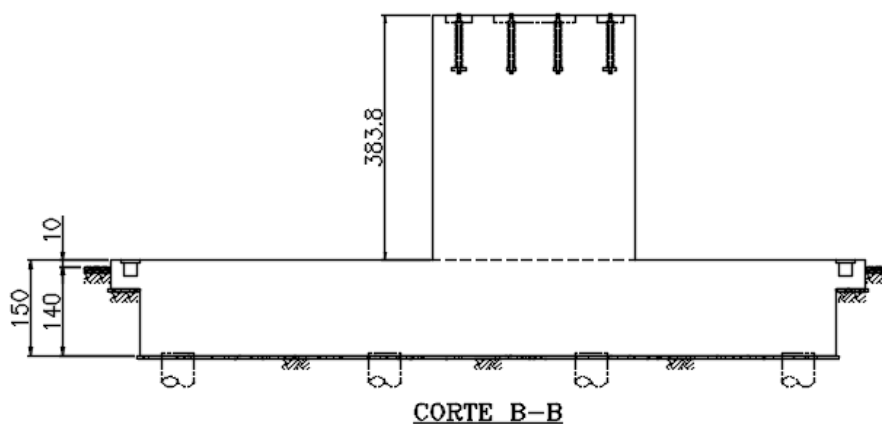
Modelo estrutural: elevação da fundação (Corte B-B)
